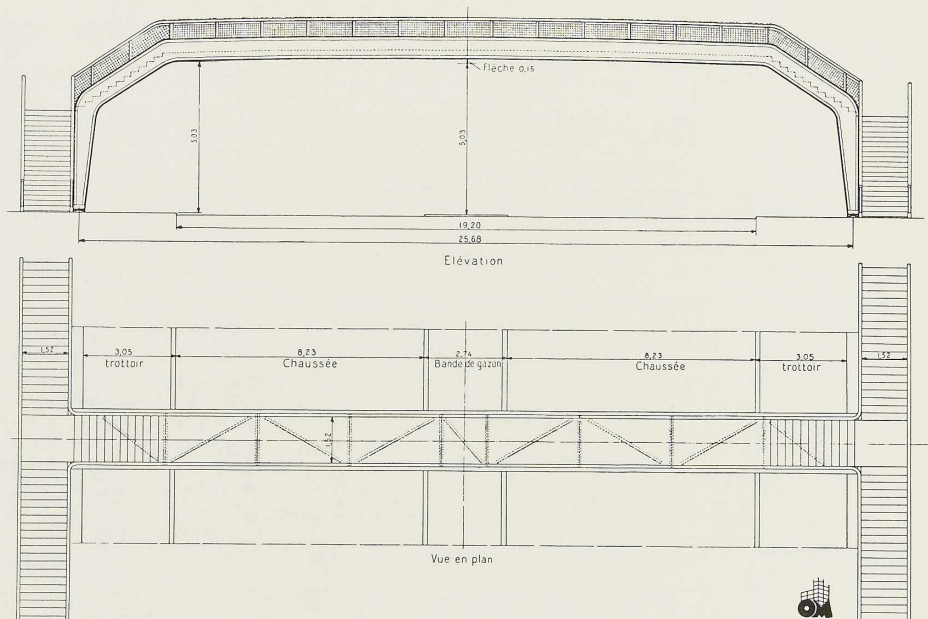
Vue de côté de la passerelle de la figure 374. End elevation of the footbridge of fig. 374. Seitenansicht der Stegbrücke der Abb. 374.
